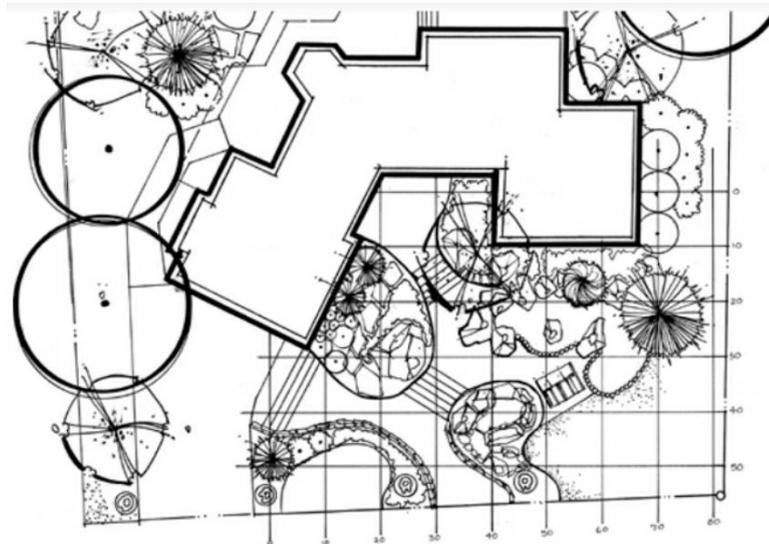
Projetista tira foto da planta arquitetônica, planejando a perspectiva¹²³
